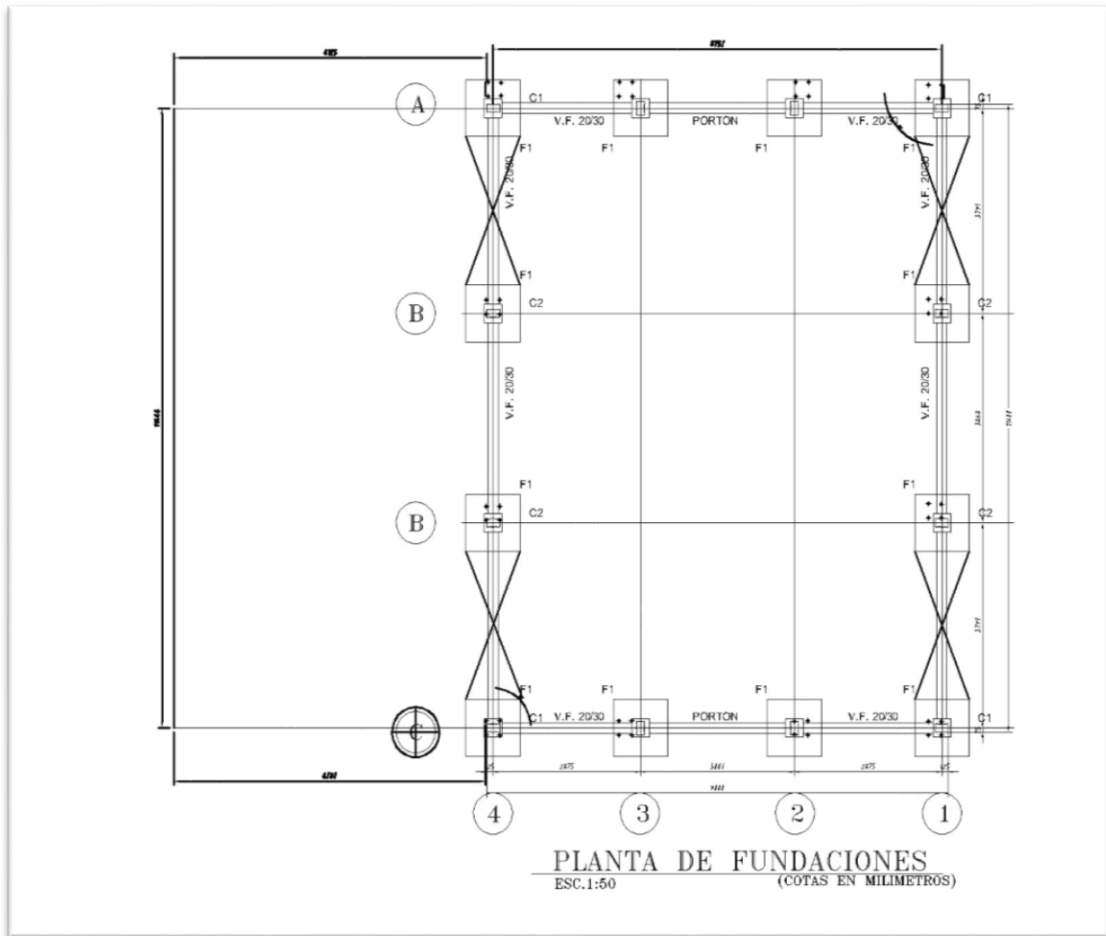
1: Planta fundaciones nave 12x9 para almacenamiento de materiales
